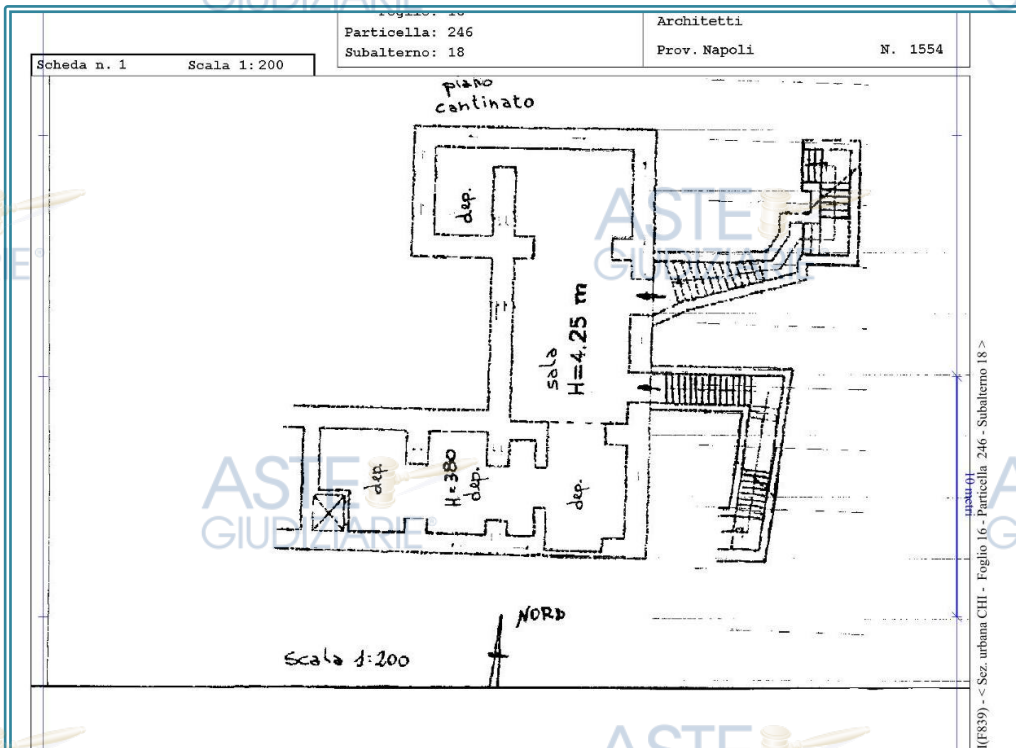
Pianta catastale attuale - Piano Interrato (cantinato)
